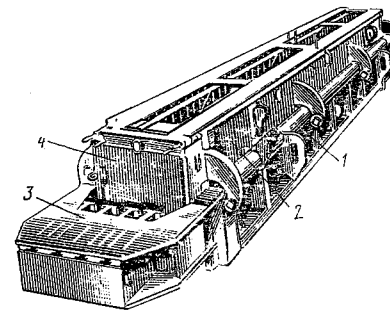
Форма для изготовления предварительно напряженных ригелей:
